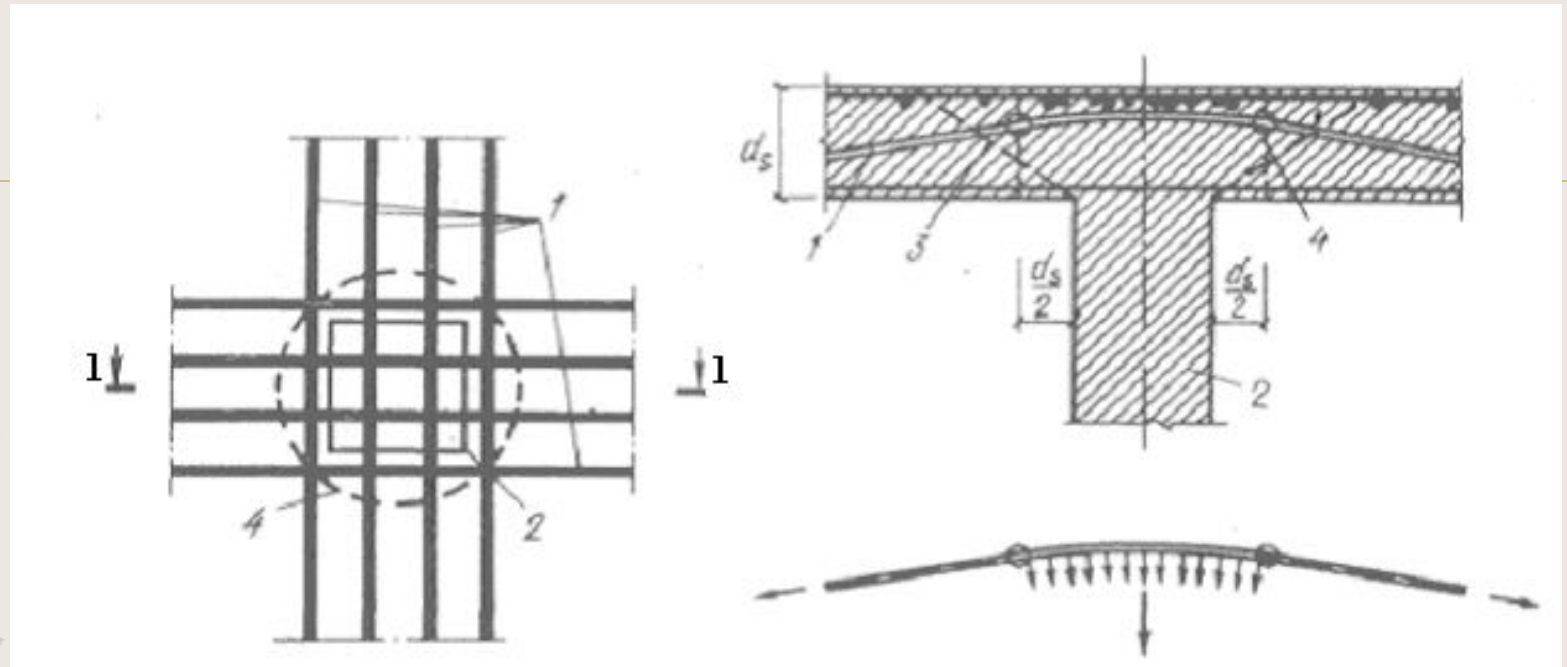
Расположение напрягаемой арматуры над колонной
